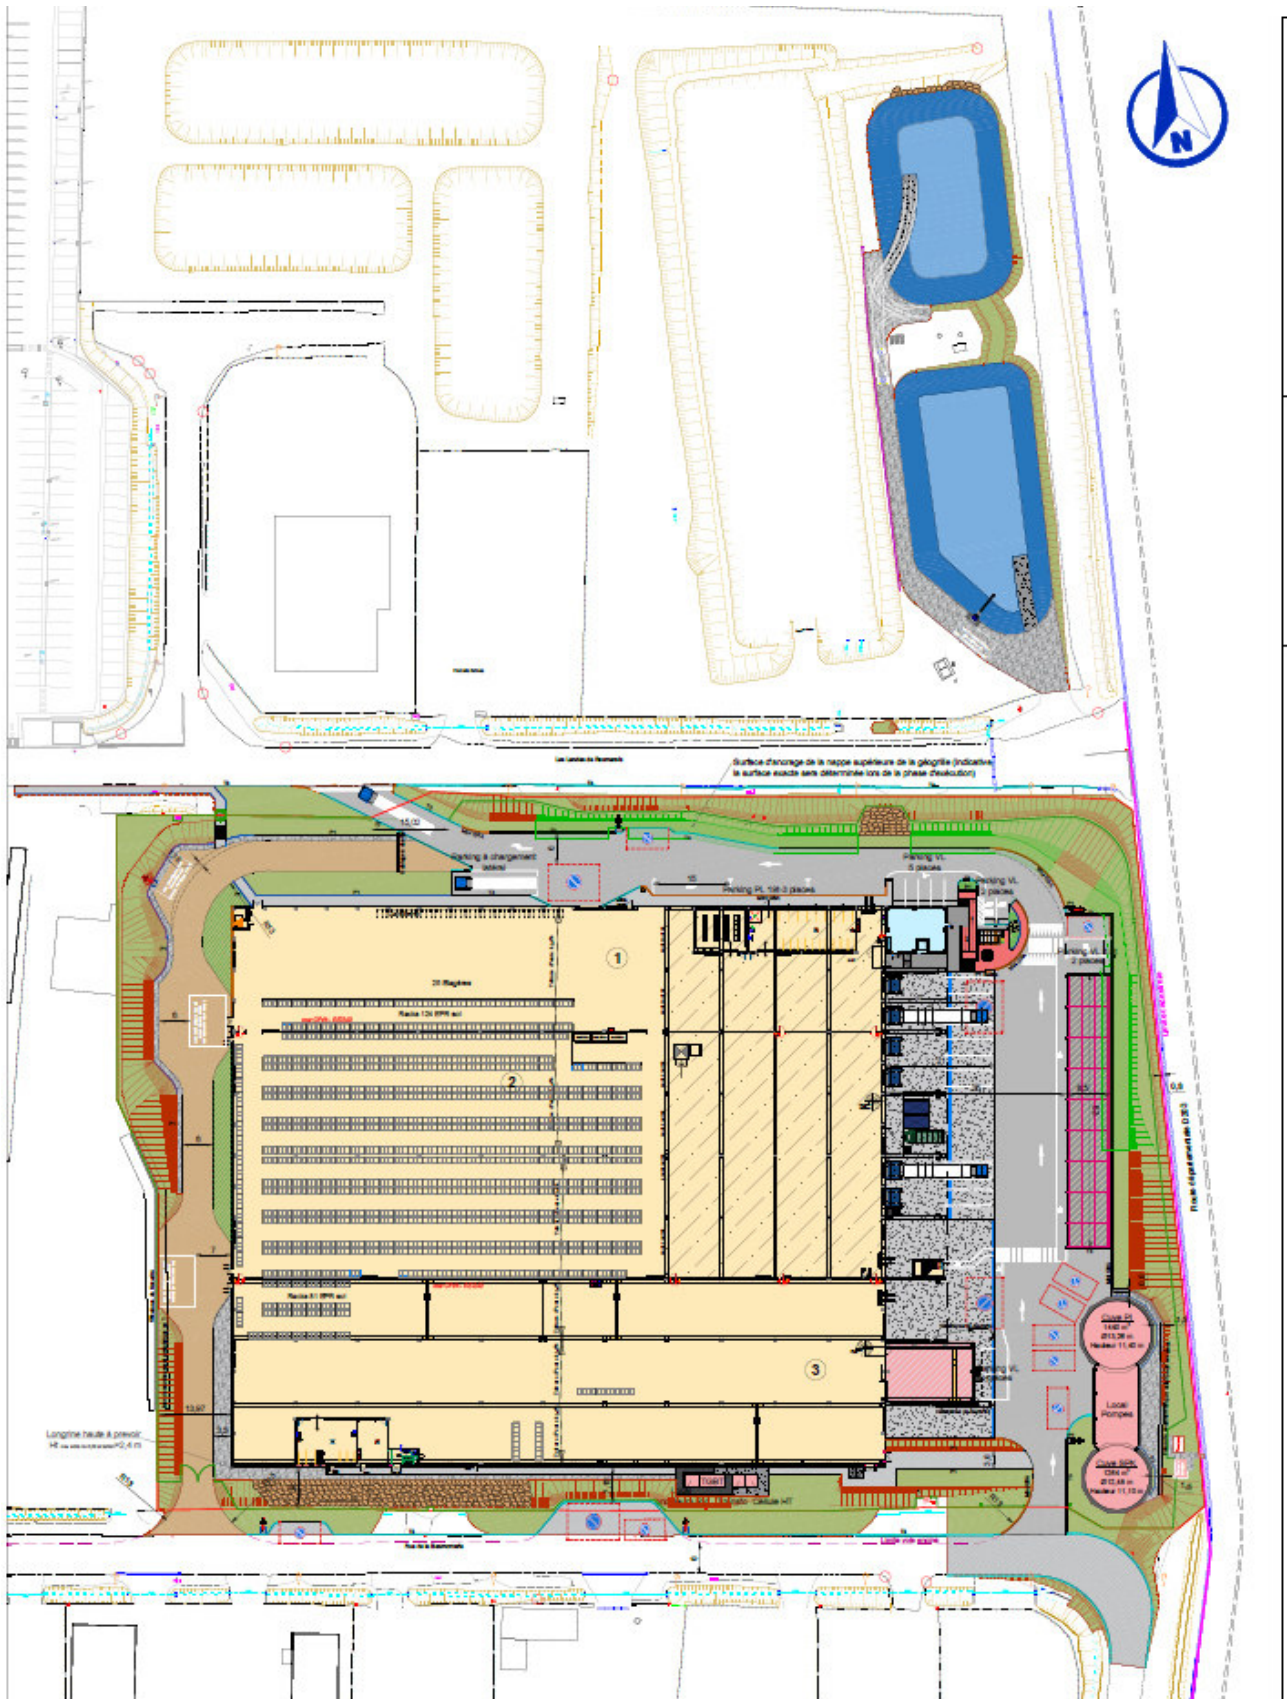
Plan d'implantation de l'entrepôt projeté (source Plan de Masse indice L du 25/09/2025)
